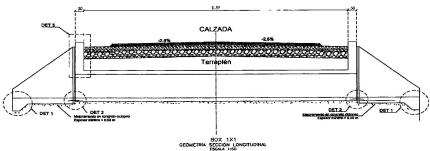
Detalle de corte longitudinal del box culvert de 1x19.
